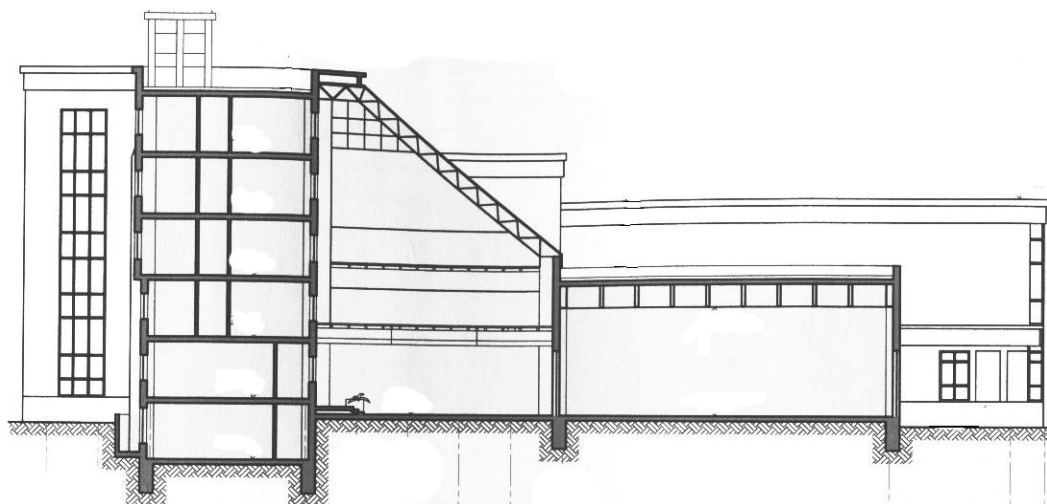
Монолитные железобетонные конструкции здания посольства России в Минске. Для перекрытия атриума применена составная наклонная металлическая ферма с параллельными поясами
